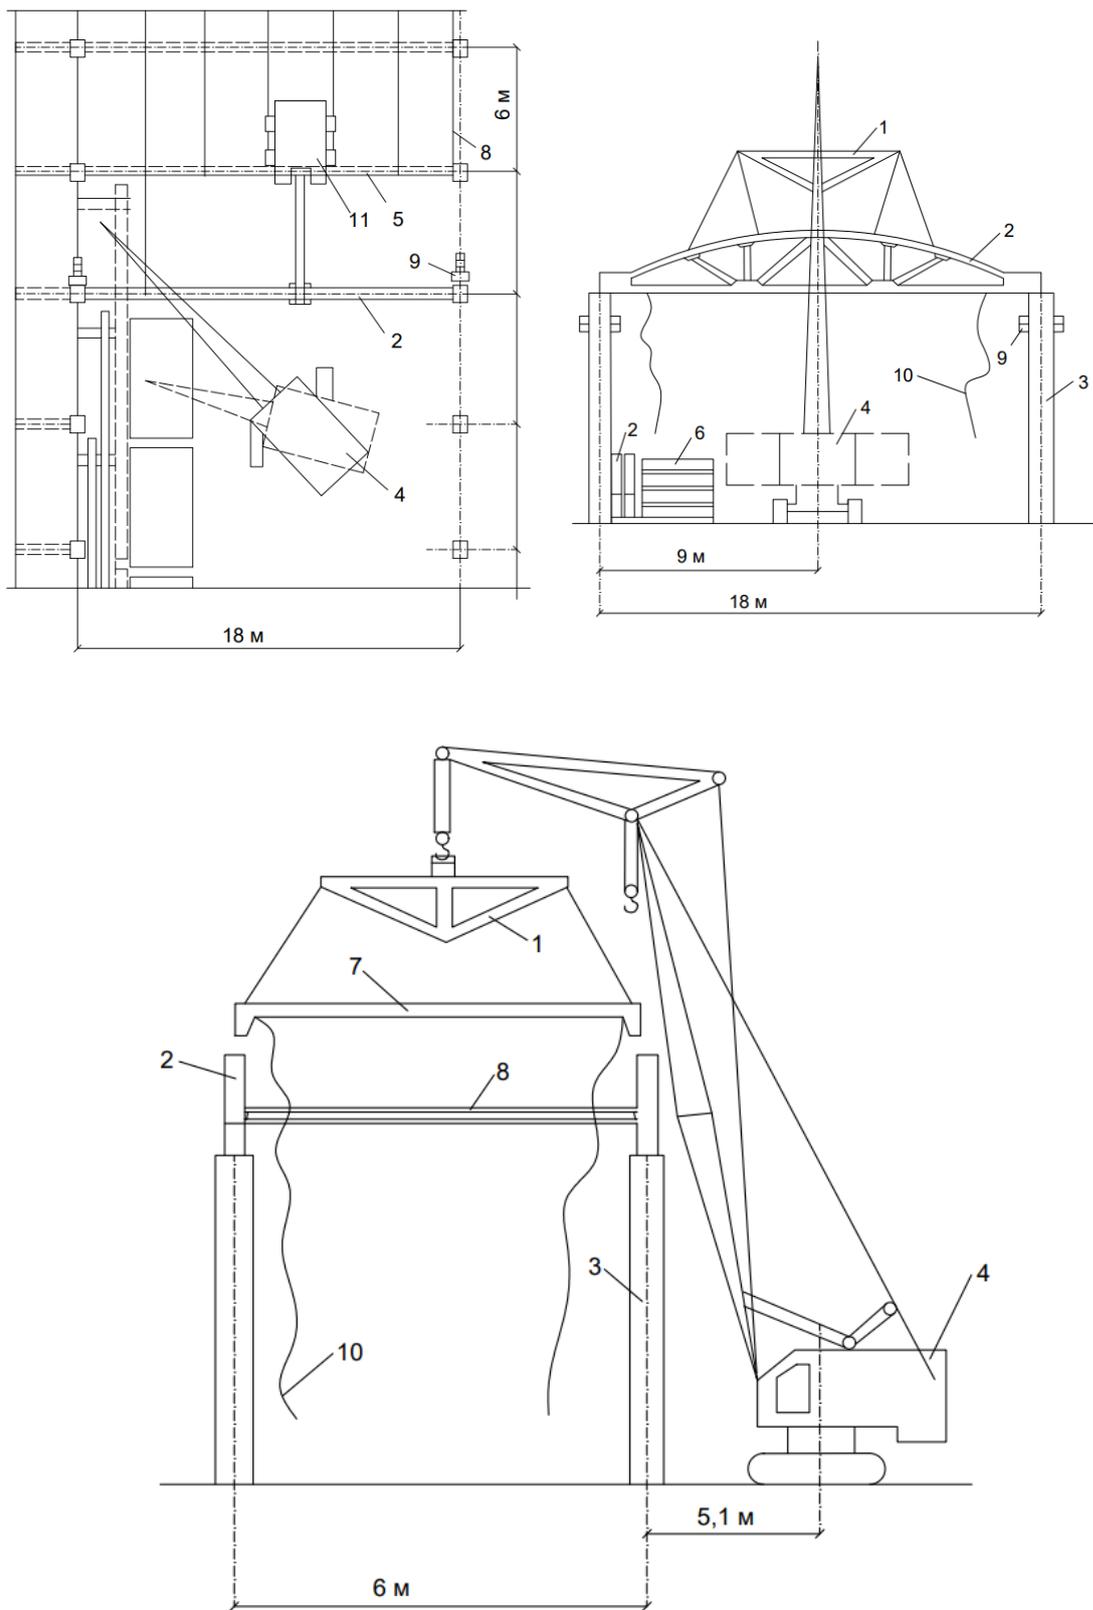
Схемы монтажа фермы и плит перекрытия:
